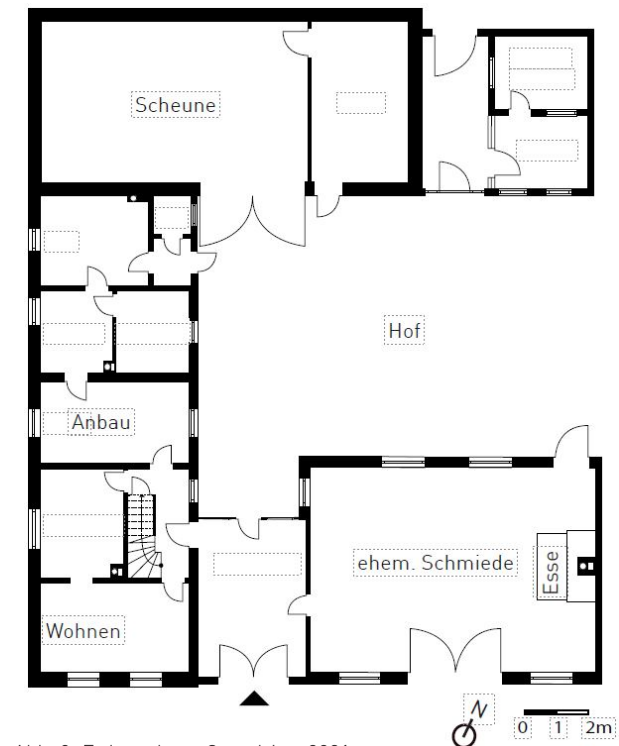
Erdgeschoss Grundriss, 2021.
